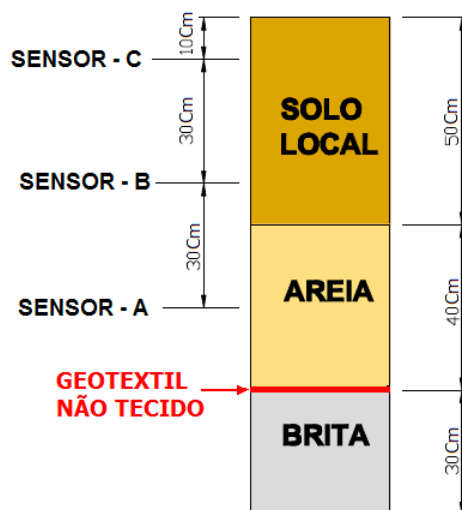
Instalação da manta geotextil não tecido na camada capilar
